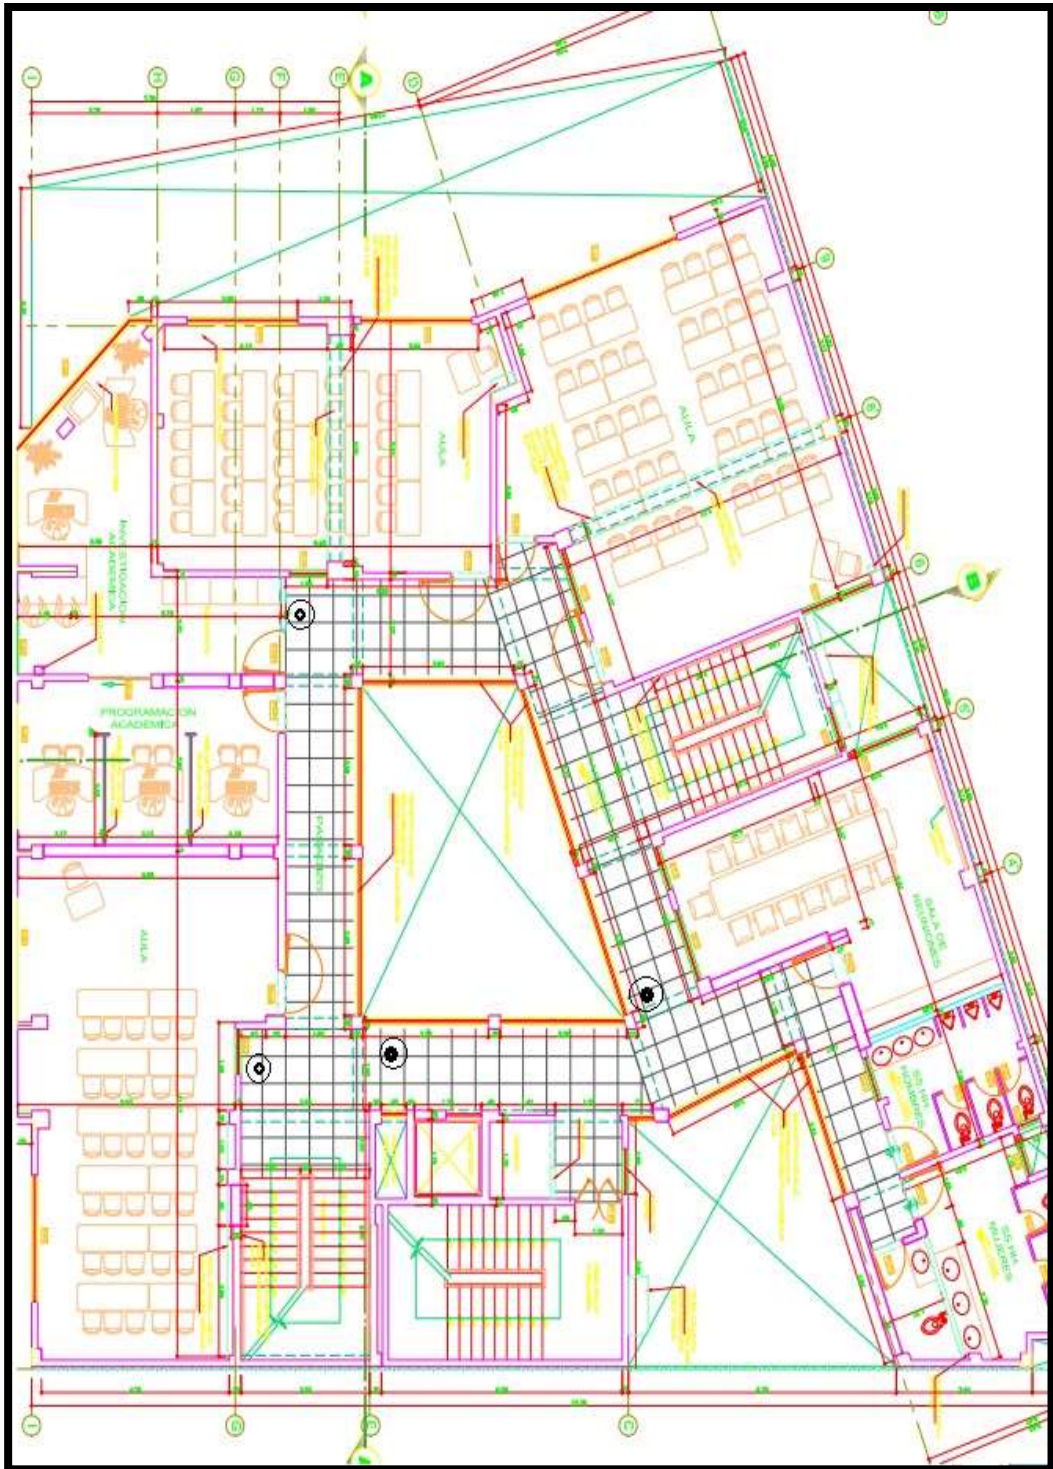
Plano de distribución de oficinas Piso 3 sede ENAP.
